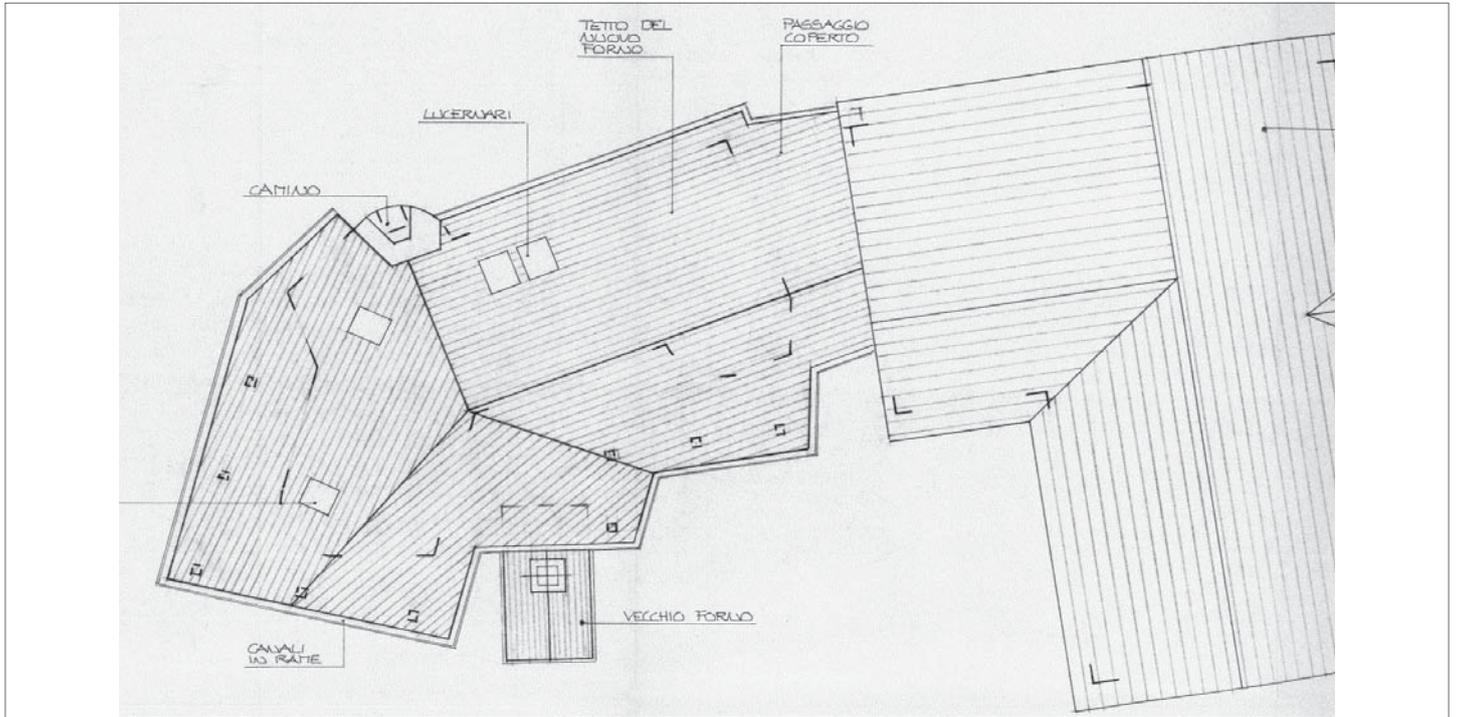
Pianta di progetto delle coperture del nuovo forno (disegno dell'arch. Stefano Andì).
